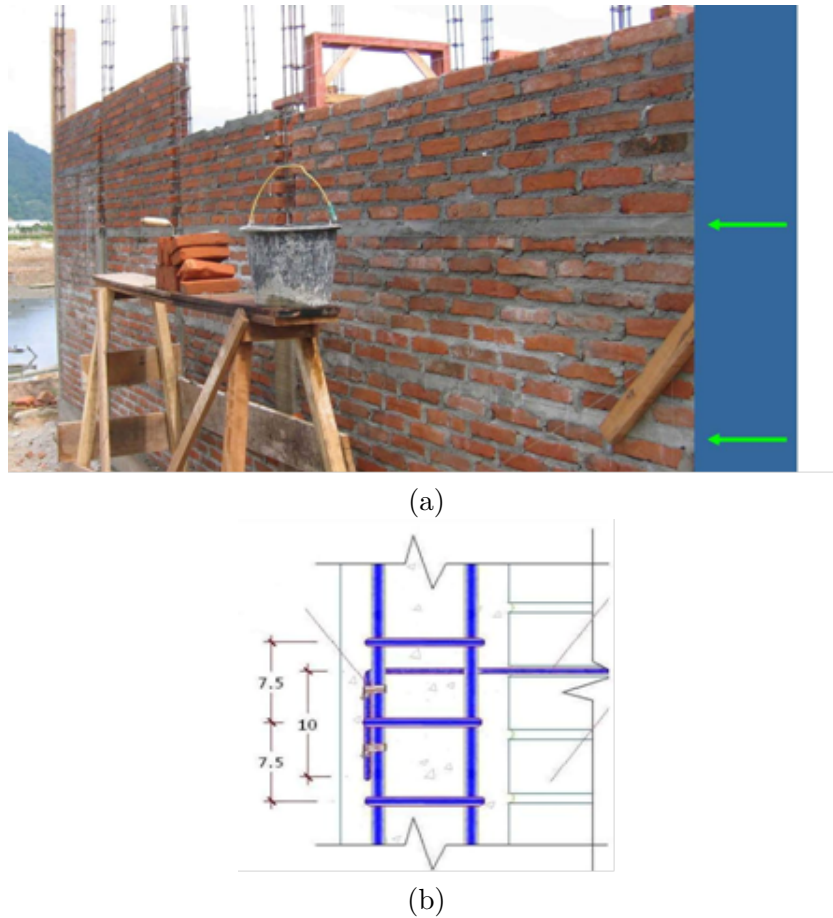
(a) Distribución de refuerzo horizontal a lo alto del paño de albañilería. (b) Anclaje en pilar de confinamiento (BuildChange, 2006)
